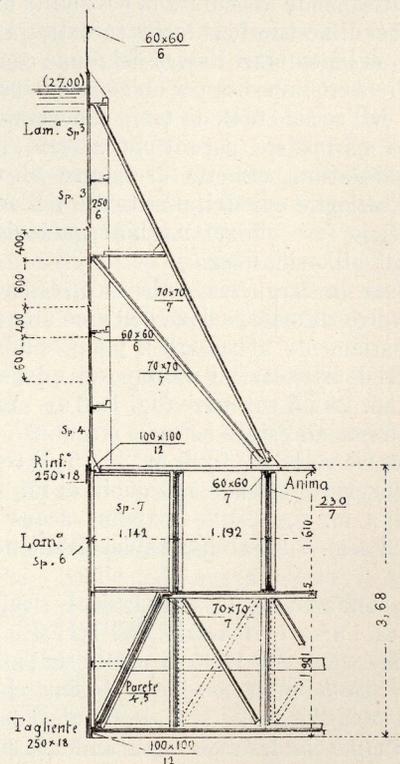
Sezione della parete verticale del cassone di fondazione.
